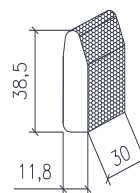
Panneau d'angle préfabriqué sans poteau d'angle (cf. tableau 8) – Pose horizontale
